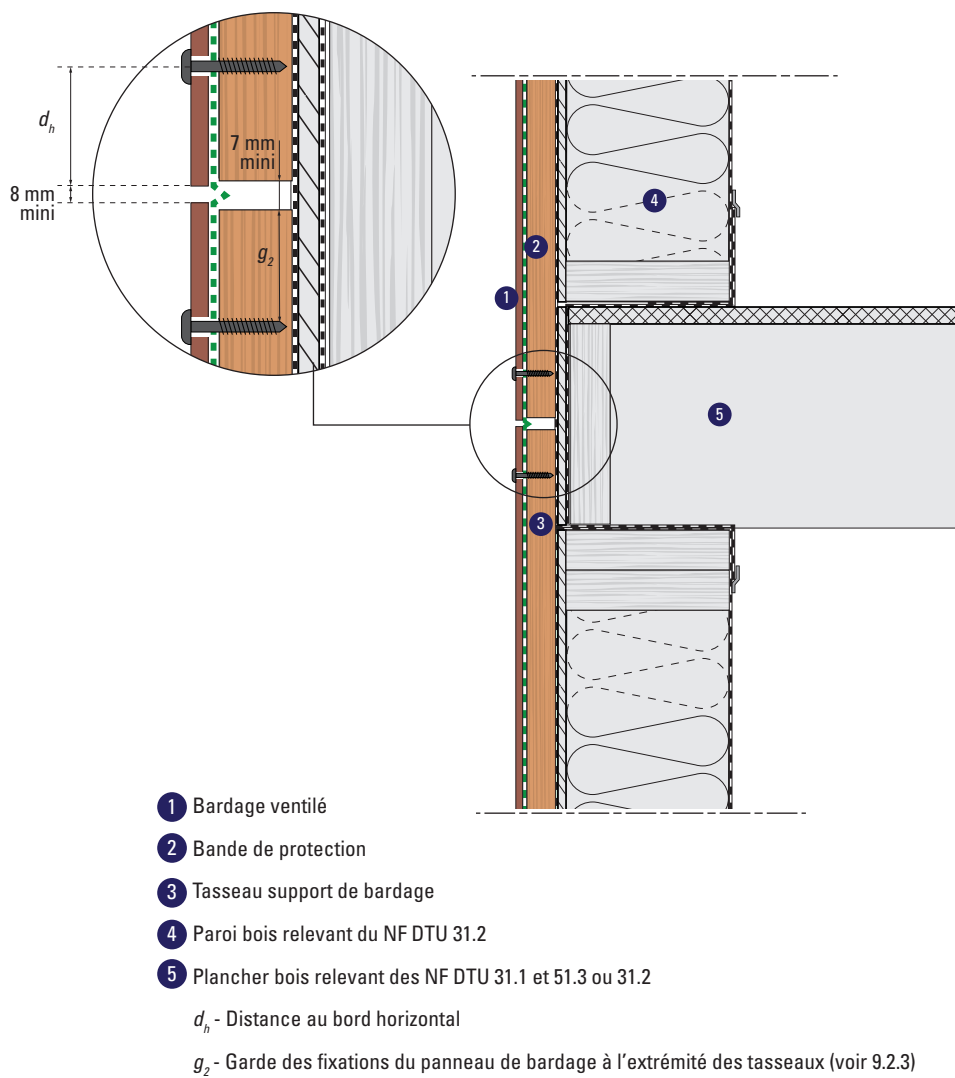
Exemple de fractionnement au droit d'un plancher bois [joints ouverts] - coupe verticale
